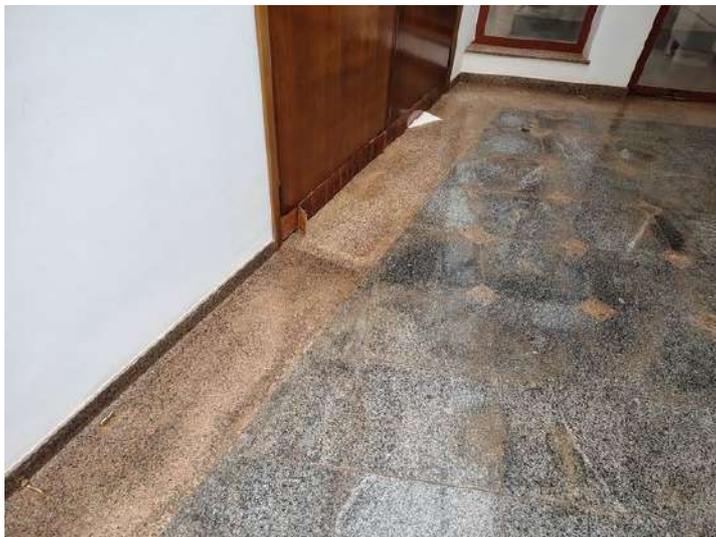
Hall Principal – Deterioração do revestimento de pedras naturais
